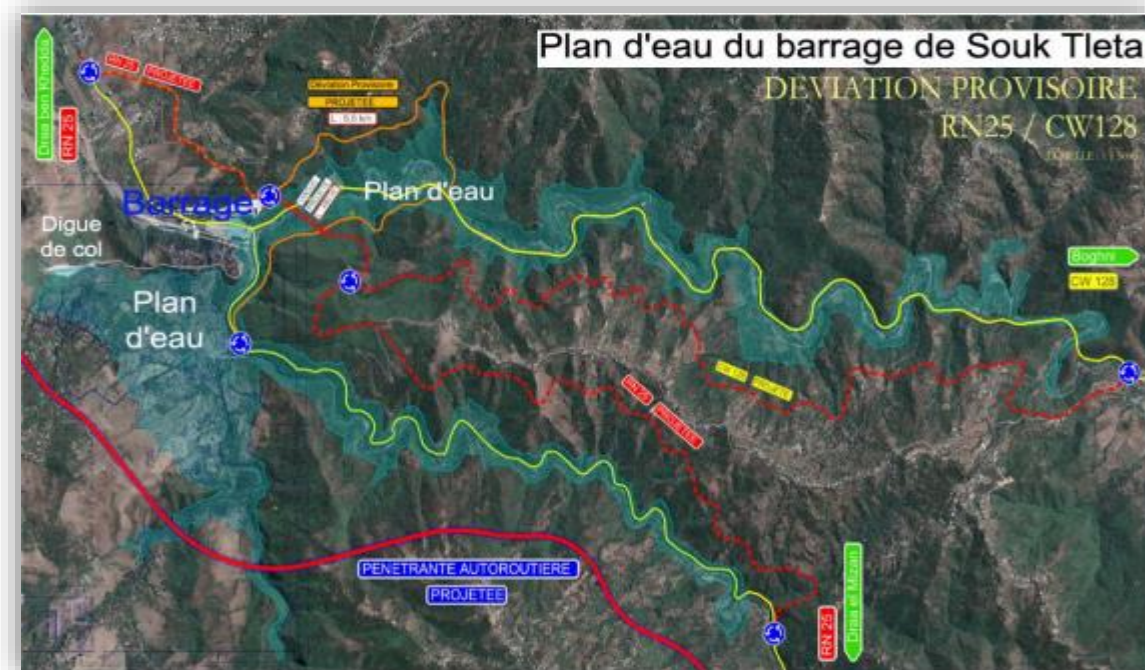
Plan d'eau du barrage de Souk-T'latha. [6]
